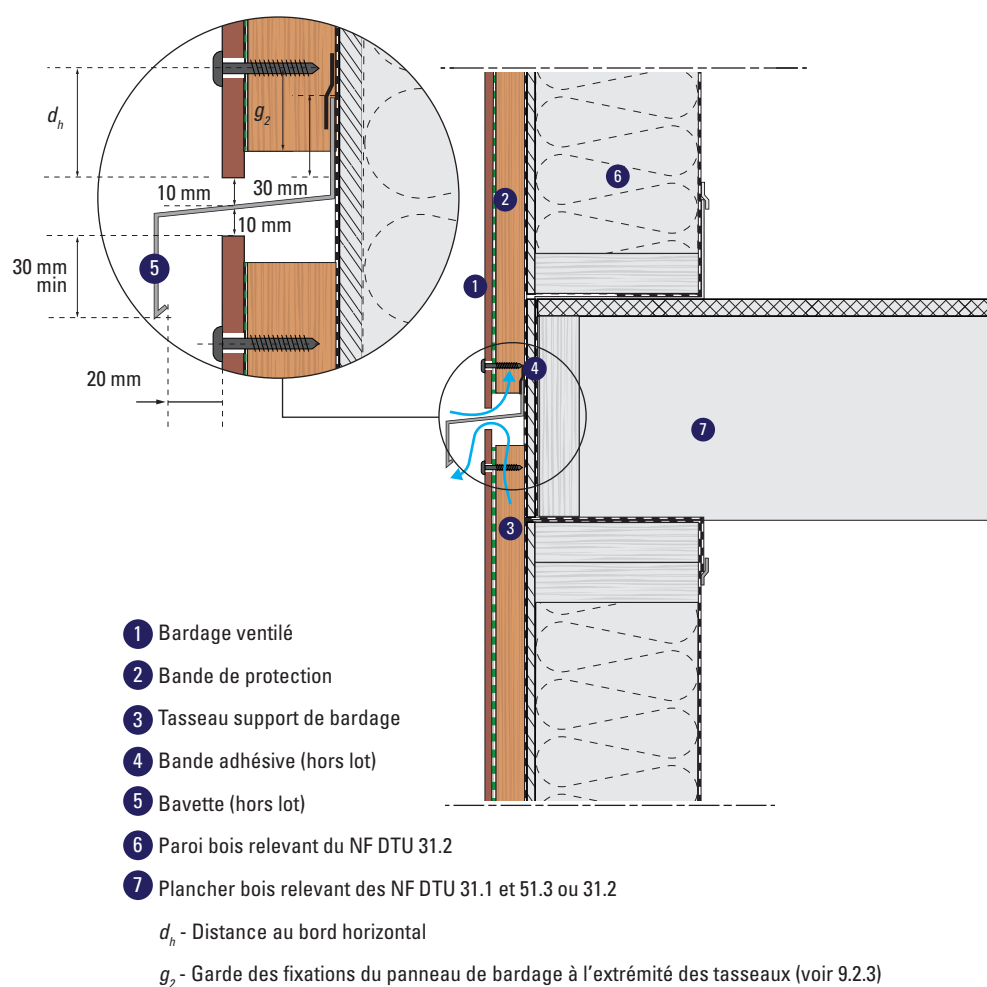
Exemple de recouplement de lame d'air en COB au droit d'un plancher bois (joints fermés) – coupe verticale
